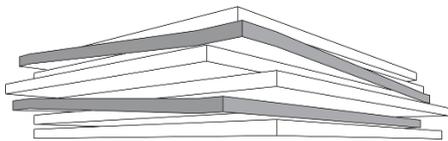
Corte esquemática dos pavimentos do edifício.
